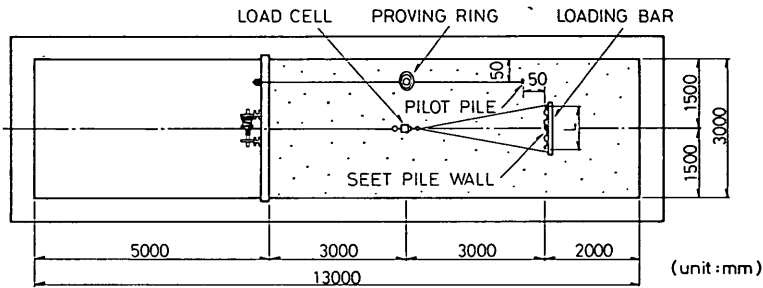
(a) 一列矢板の水平載荷試験の装置(No.1~4) (平面図)
